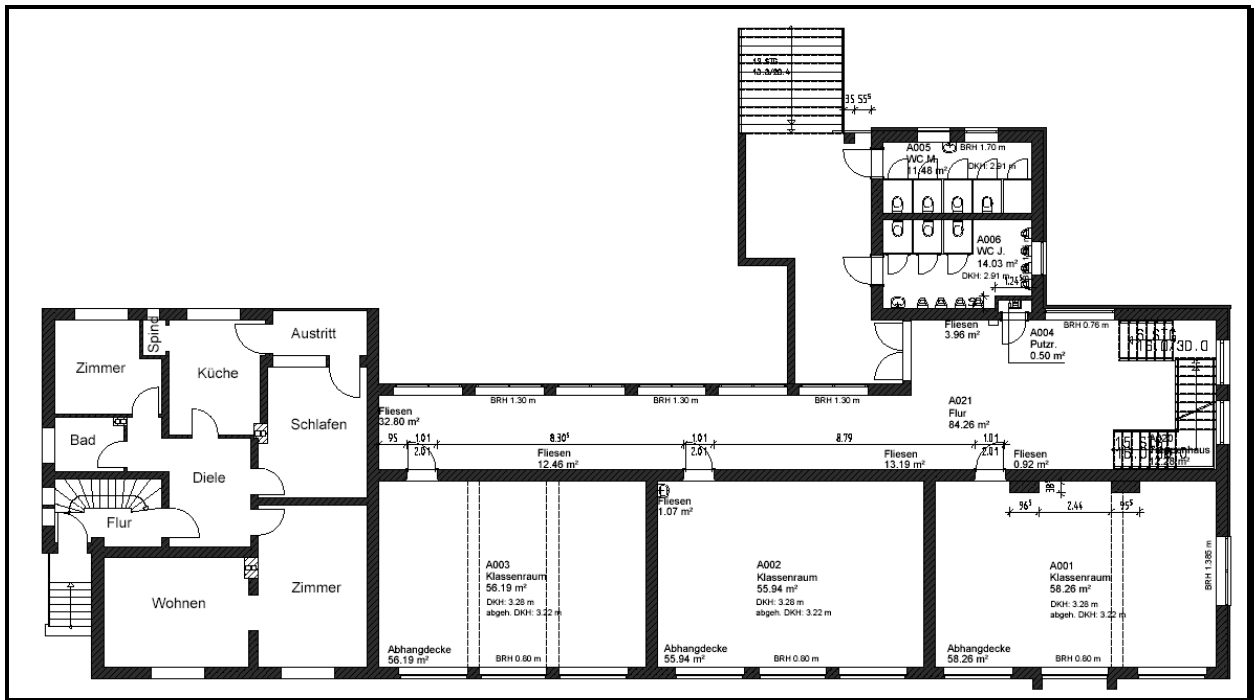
Friedrich-Ebert-Realschule: Erdgeschossgrundriss Bauteil A
